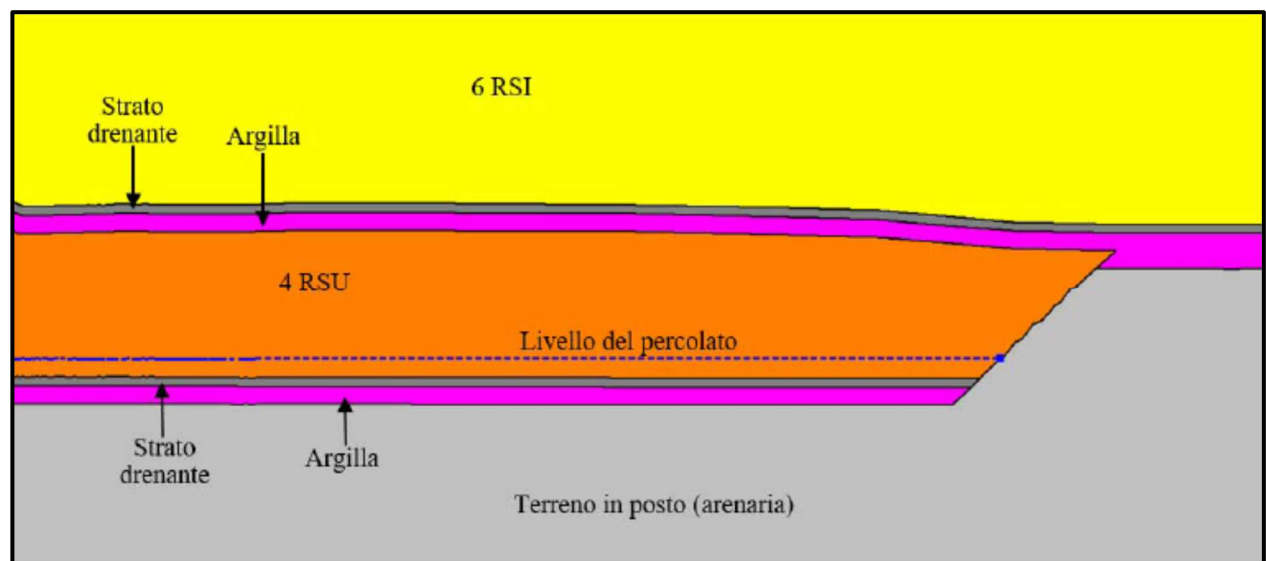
/VI – Sezione A-A' – Sponda sud-ovest - Particolare 2
